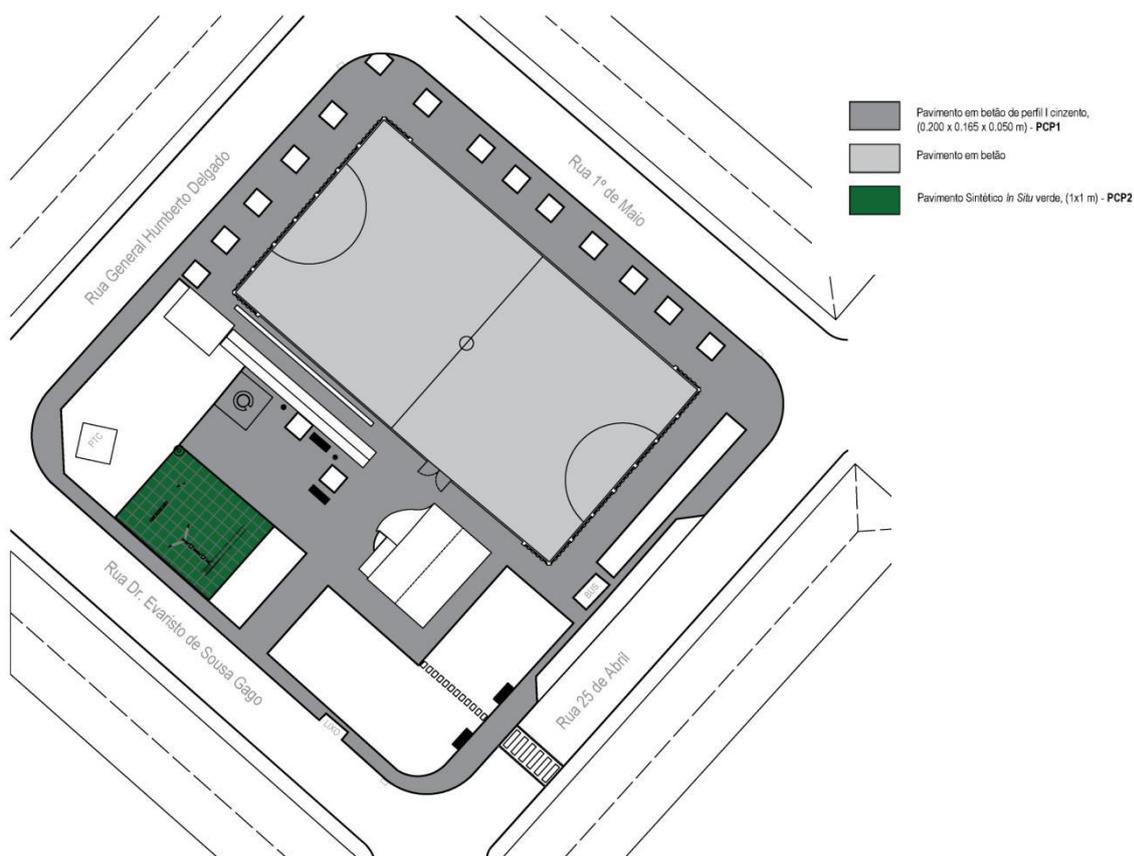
Planta de Pavimentos propostos para o Jardim do Futuro (Fonte: autora)
